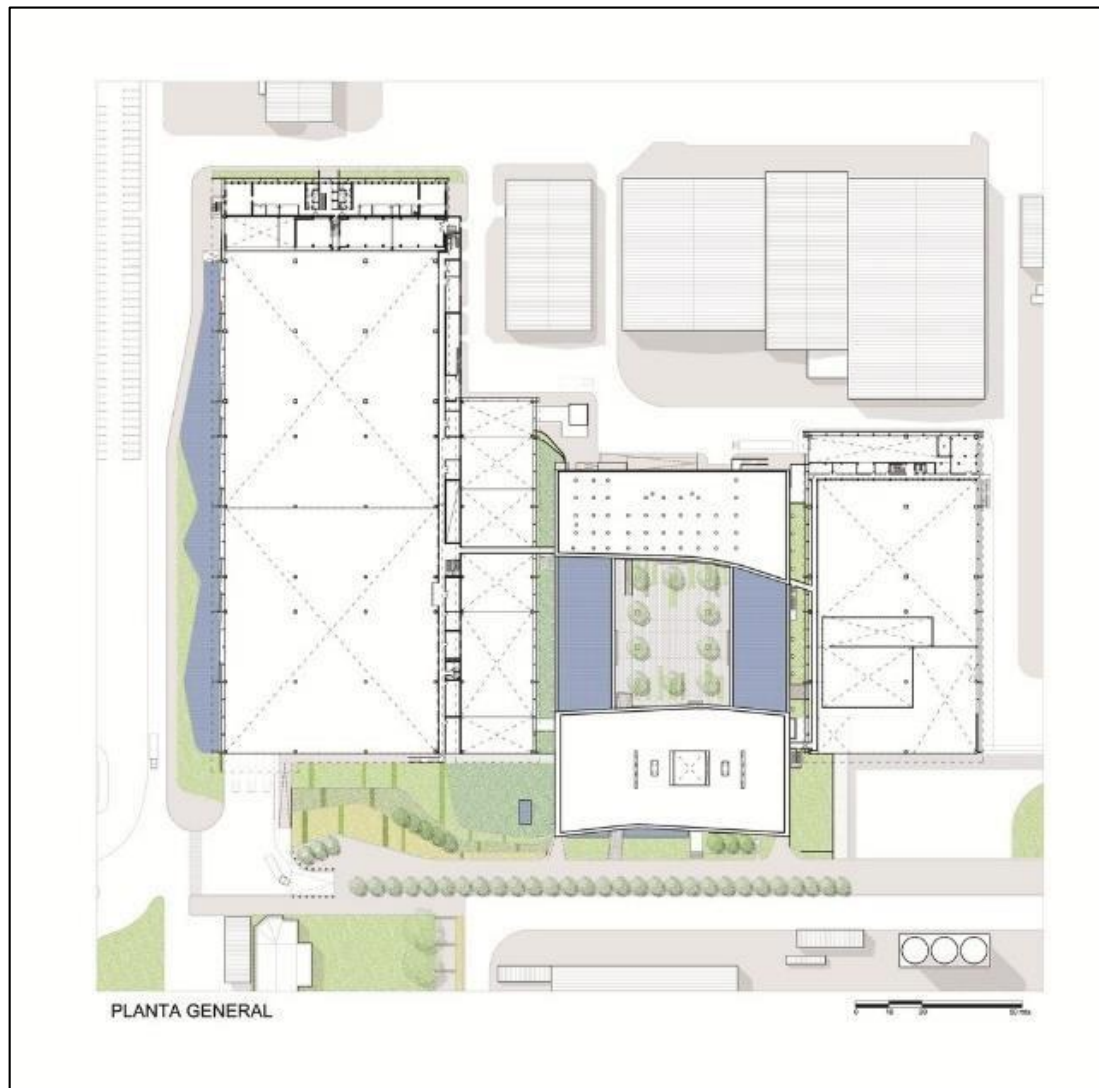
Plot Plan de fábrica Carozzi, Fuente: Archdaily.pe
